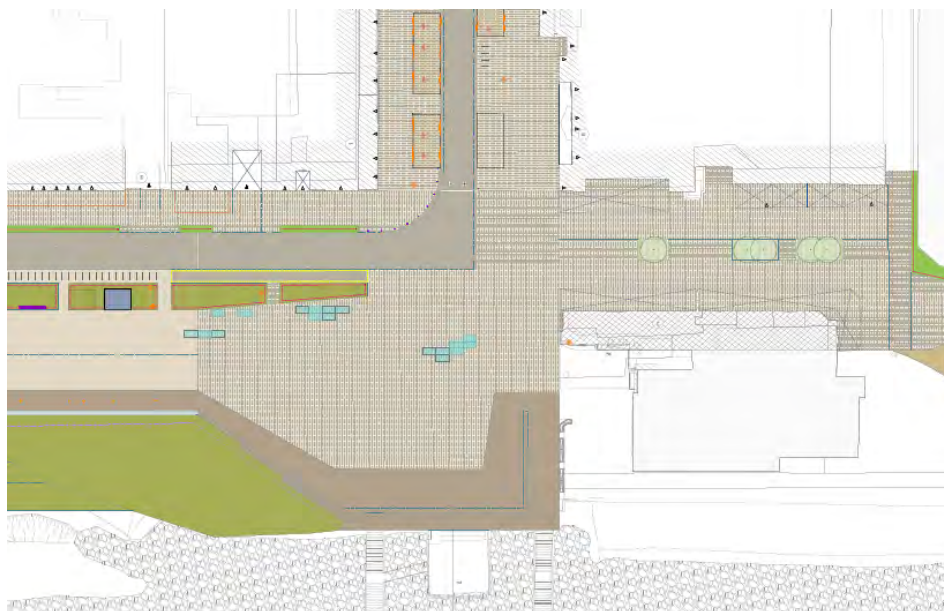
Plan masse de la place rouge - belvédère et passage Lacaze à long terme – suppression du poste de secours
